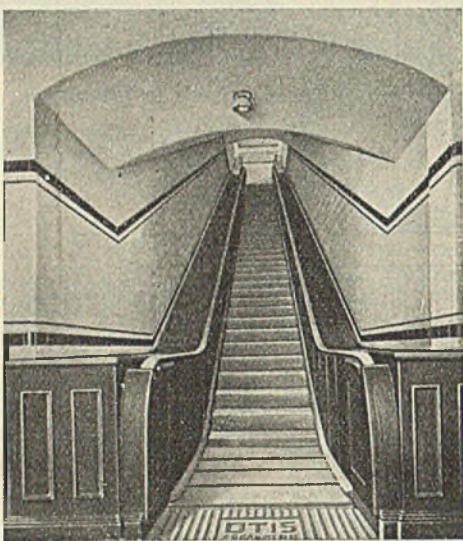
Bewegliche Treppe auf der Park Street Station der Untergrundbahn in Boston.
